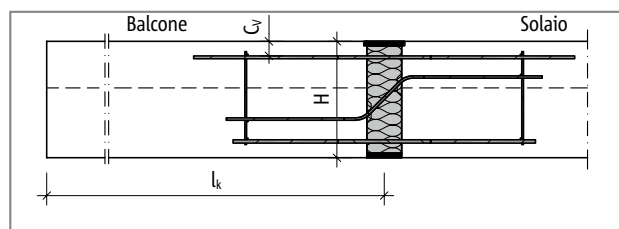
Schöck Isokorb® XT tipo BP: schema statico
